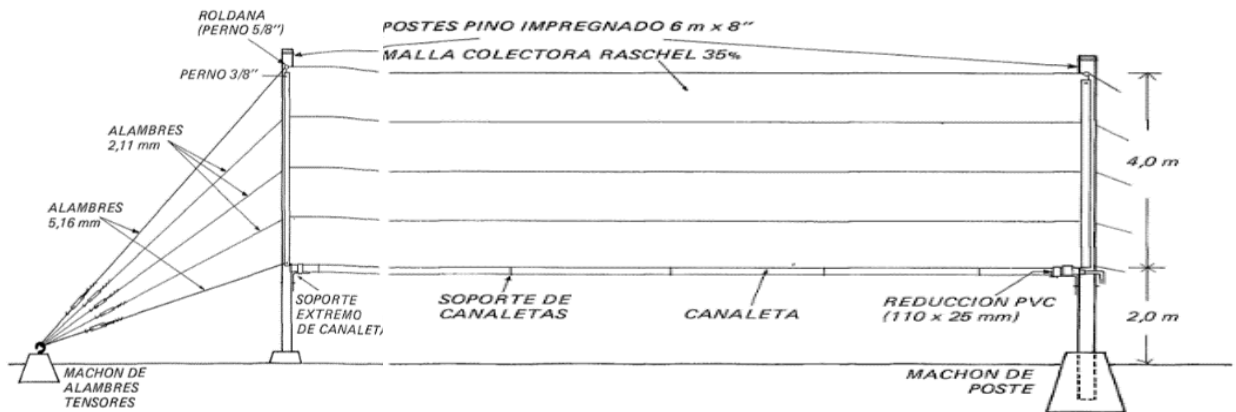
Se detallan los materiales empleados para la construcción de un atrapanieblas desde una vista horizontal
